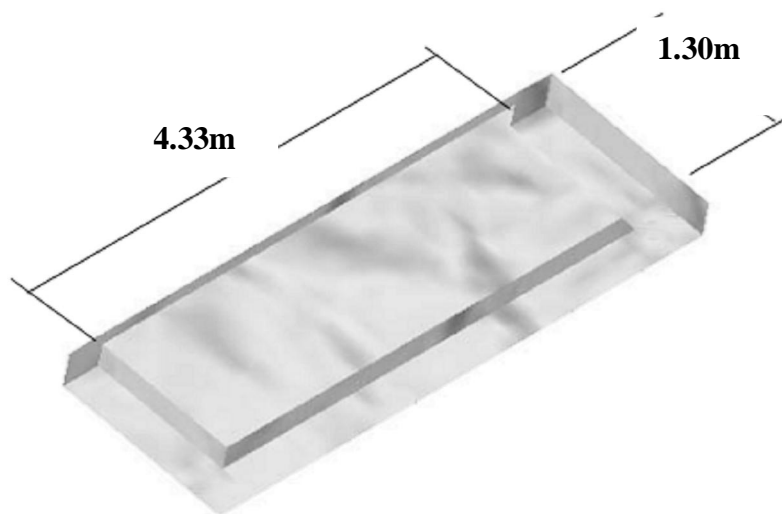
Dalle pleine sur 3 appuis continus.
